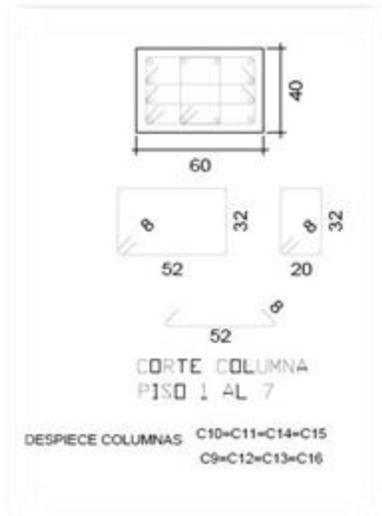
Detalle columnas C9, C10, C11, C12, C13, C14, C15, C16
